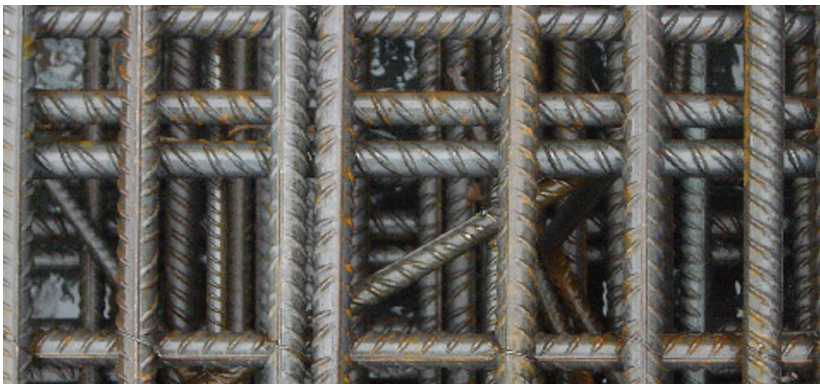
Von oben ist die Kompaktheit der unteren Lagen in einer Bodenplatte gut erkennbar. Sie lässt die Schwierigkeit der Bestimmung der Maßkette erkennen. Erkennbar sind die Walznahten, die bei allen Stäben im Einbau unterschiedlich verlaufen.
